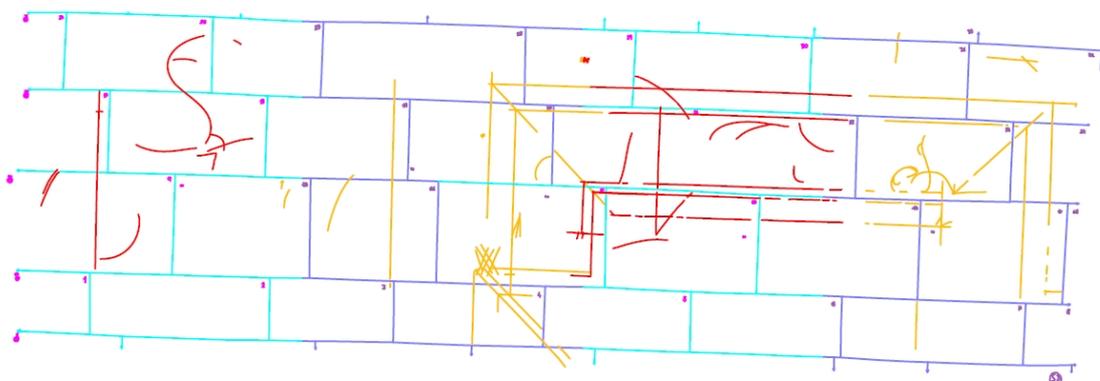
Versión editada del alzado Sur 3, en la que se han eliminado los tramos duplicados.
